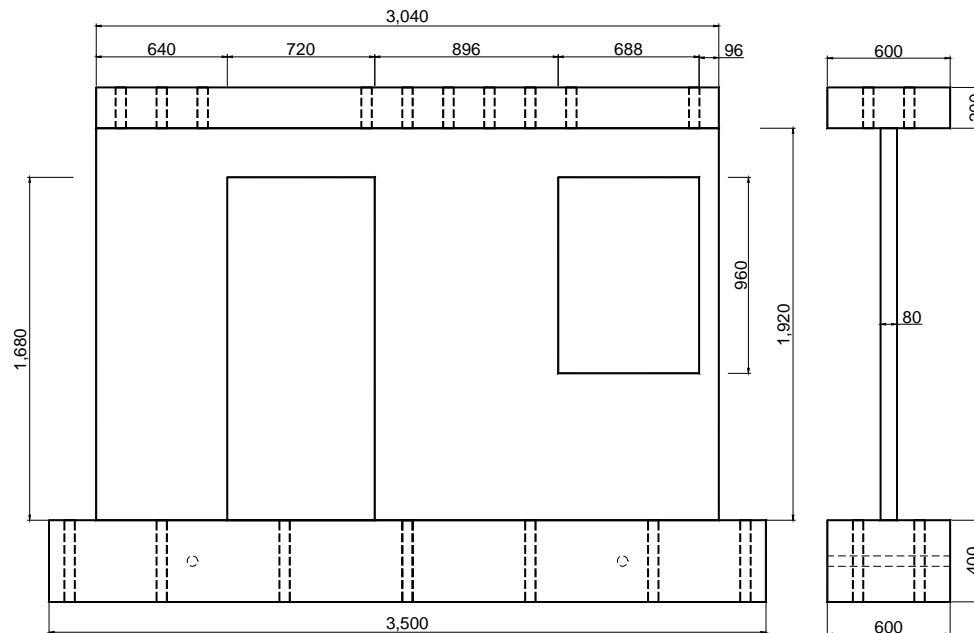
Geometría (nominal) de los modelos de muros con aberturas en escala 1:1.25 (dimensiones en mm)
